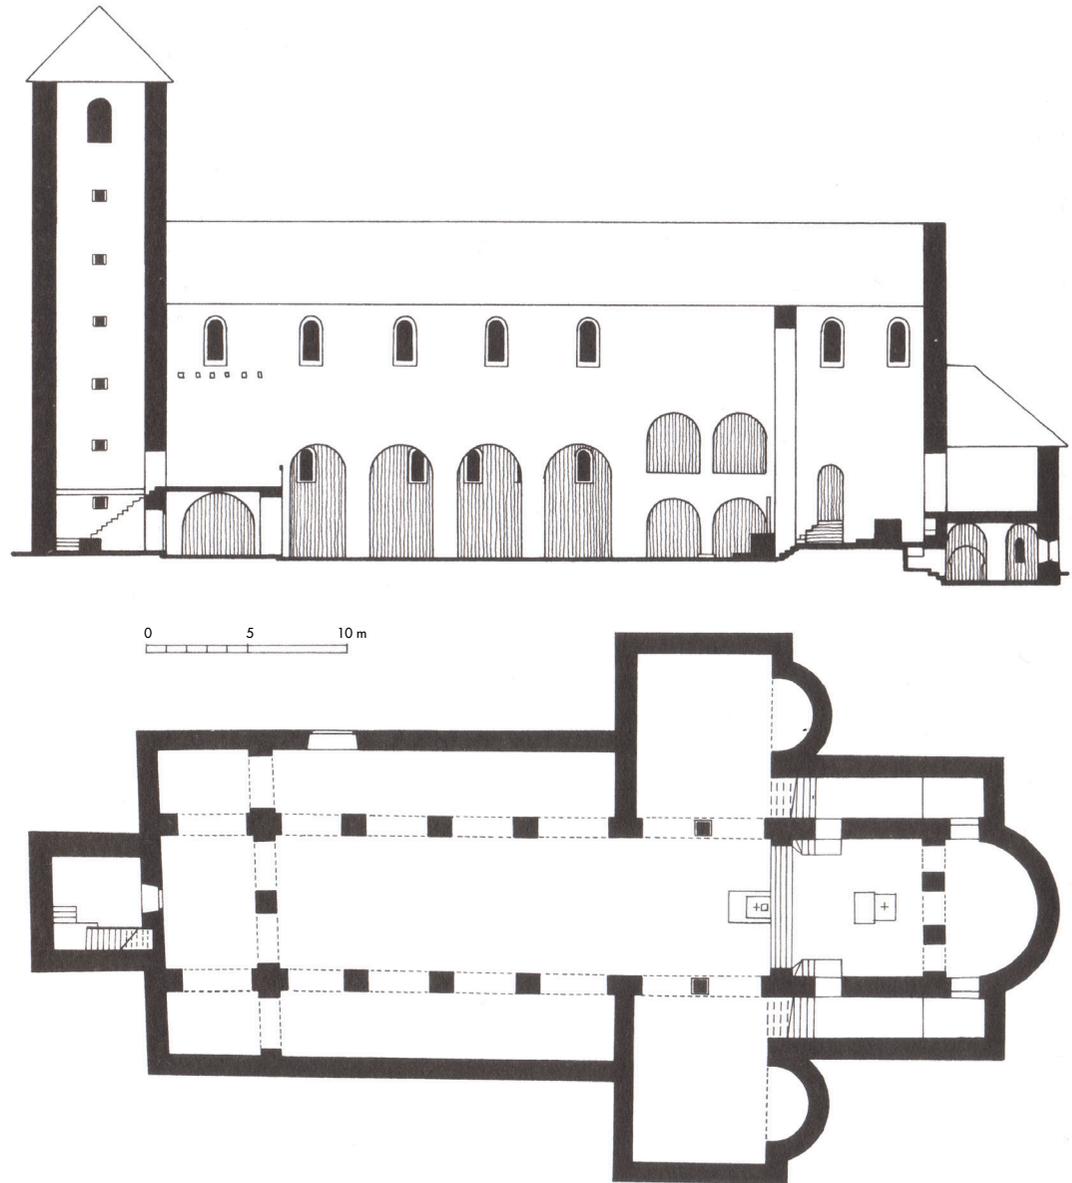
Meschede, ehem. Damenstiftskirche. Schnitt und Grundriss für die Zeit um 900. Nur das Obergeschoss hatte einen apsisähnlichen Grundriss, während der Ostschluss auf Kryptenniveau durch zwei viertelkreisförmige Pfeiler in Umgang und Apsis geschieden war.
